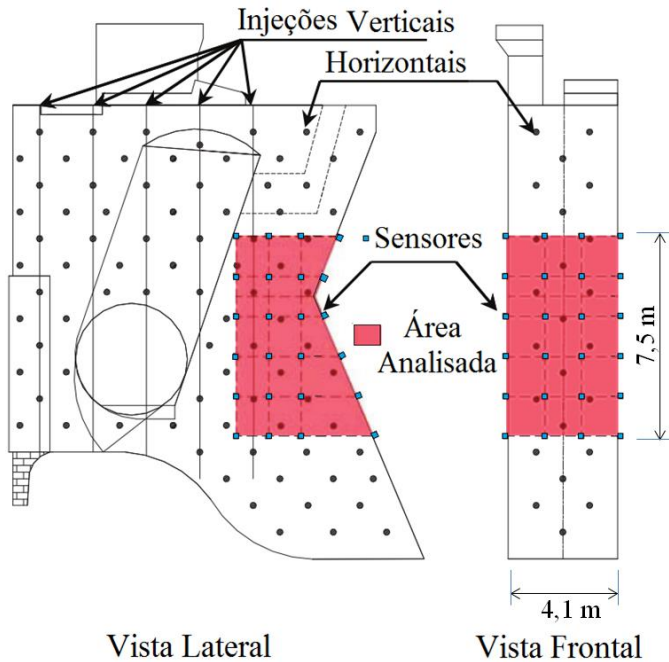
Estrutura restaurada com os pontos de injeções e a área analisada
